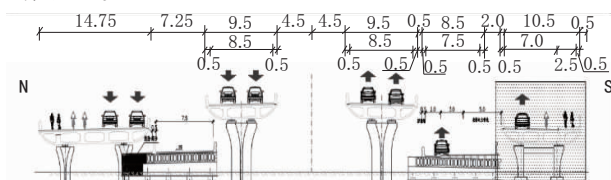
冬涟桥断面布置示意图(施工期间)(单位:m)
